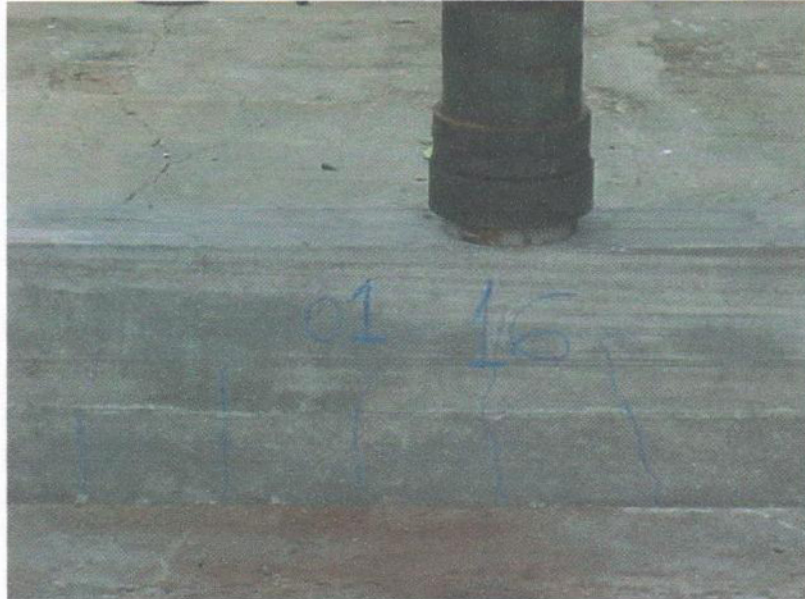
Ocorrência de fissuras durante o ensaio (Amostra 01 – concreto Fck 16Mpa).
